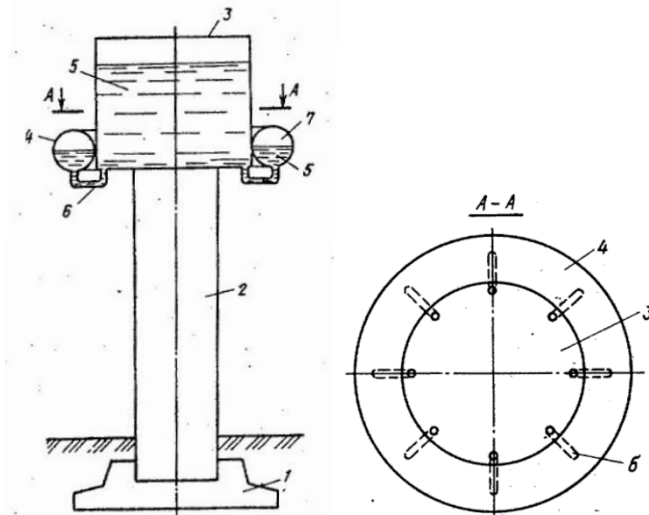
Конструктивная схема внешней пневмозащиты резервуара [7, с.58]:
